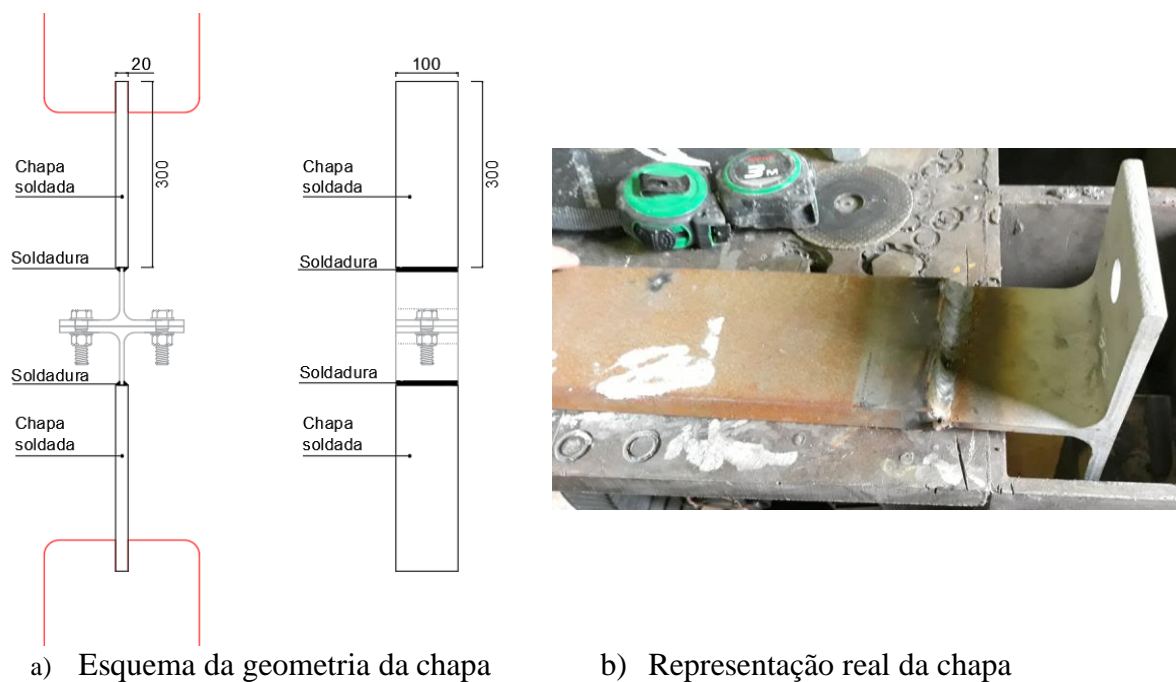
Chapa soldada a alma do T-Stub (dimensões em mm)
